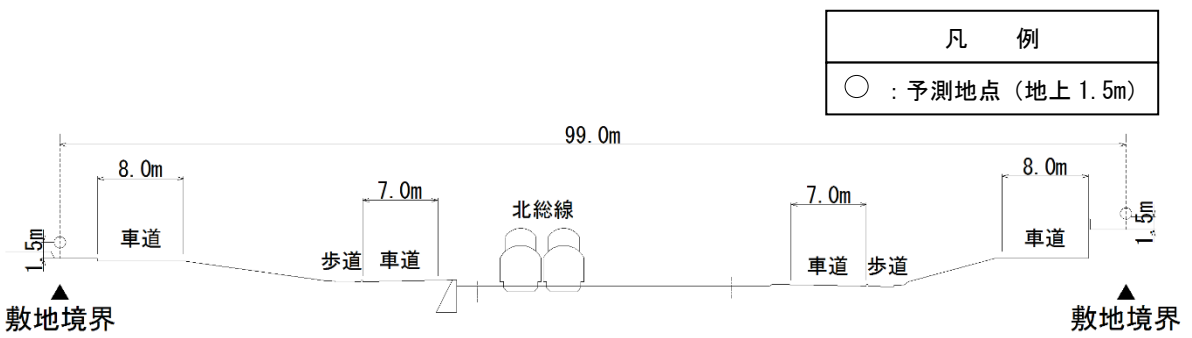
(11) 予測断面図 (K. 一般国道464号 (7))
